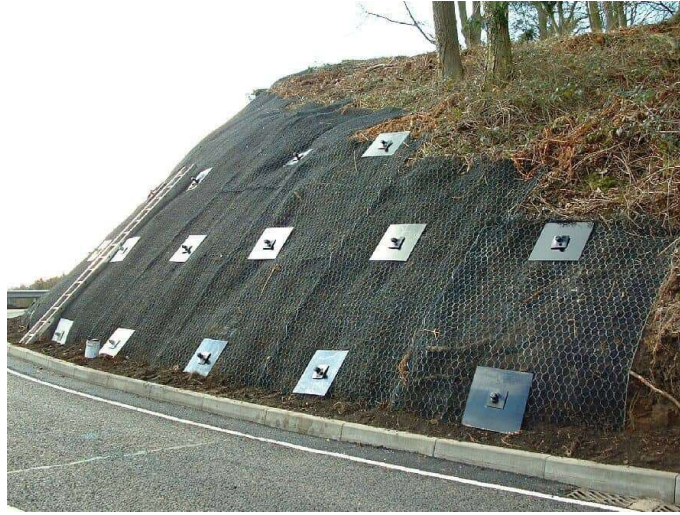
Talud protegido con soil nailing recubierto con geotextil.
